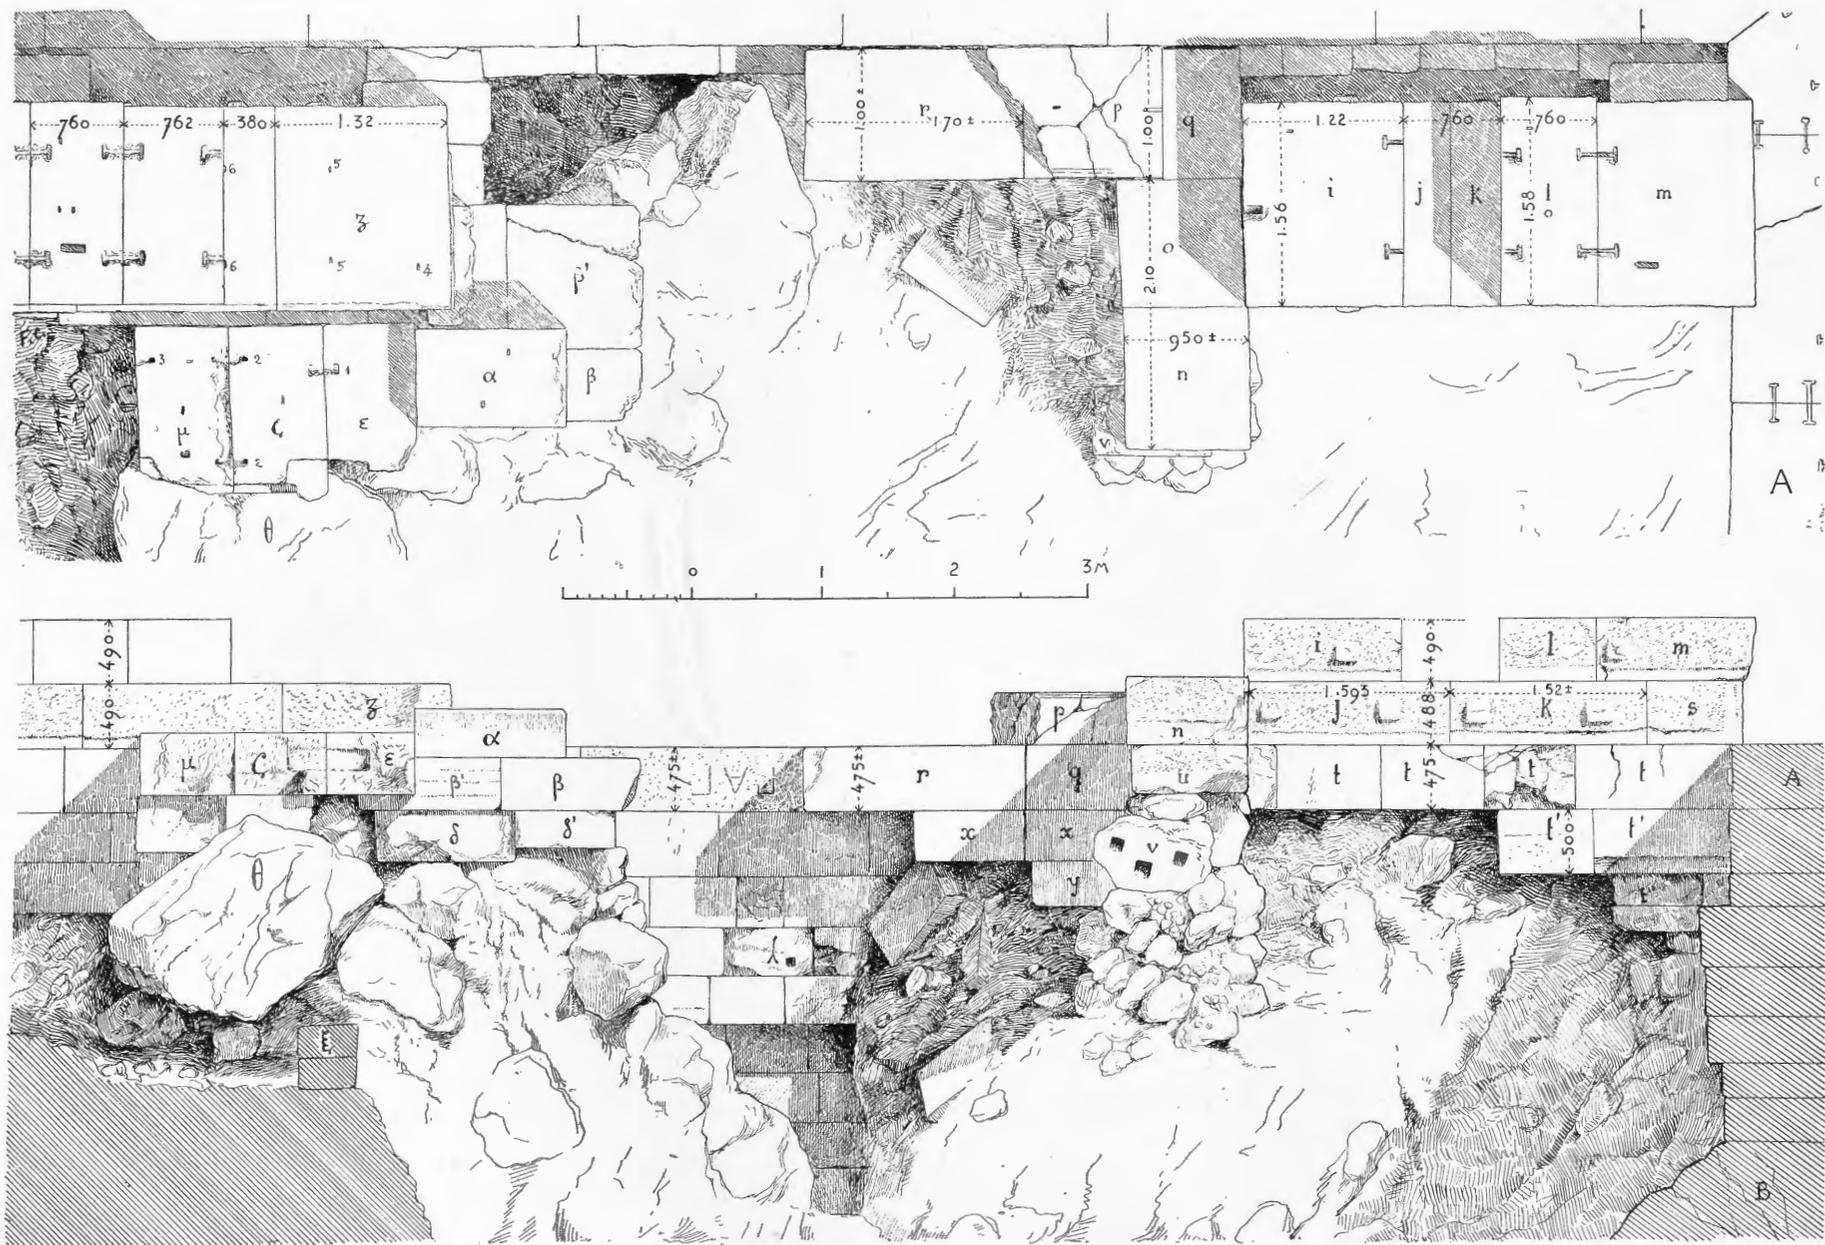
Plan et élévation des soubassements de la colonnade ionique Sud (extrémité Ouest) et de la construction qui les traversait (état au moment des fouilles).
